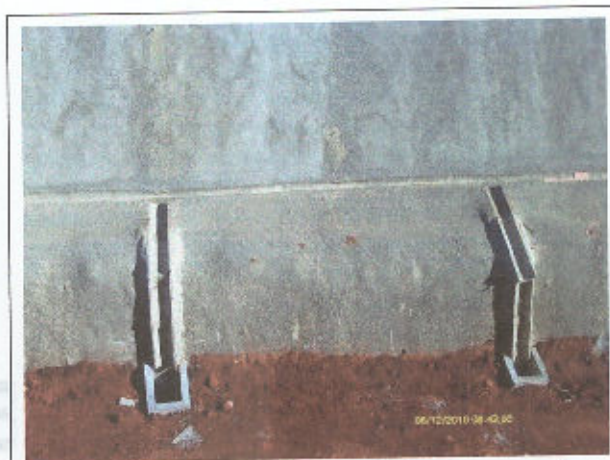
Instalação da drenagem superficial para escoamento das águas pluviais do talude - Concluída
